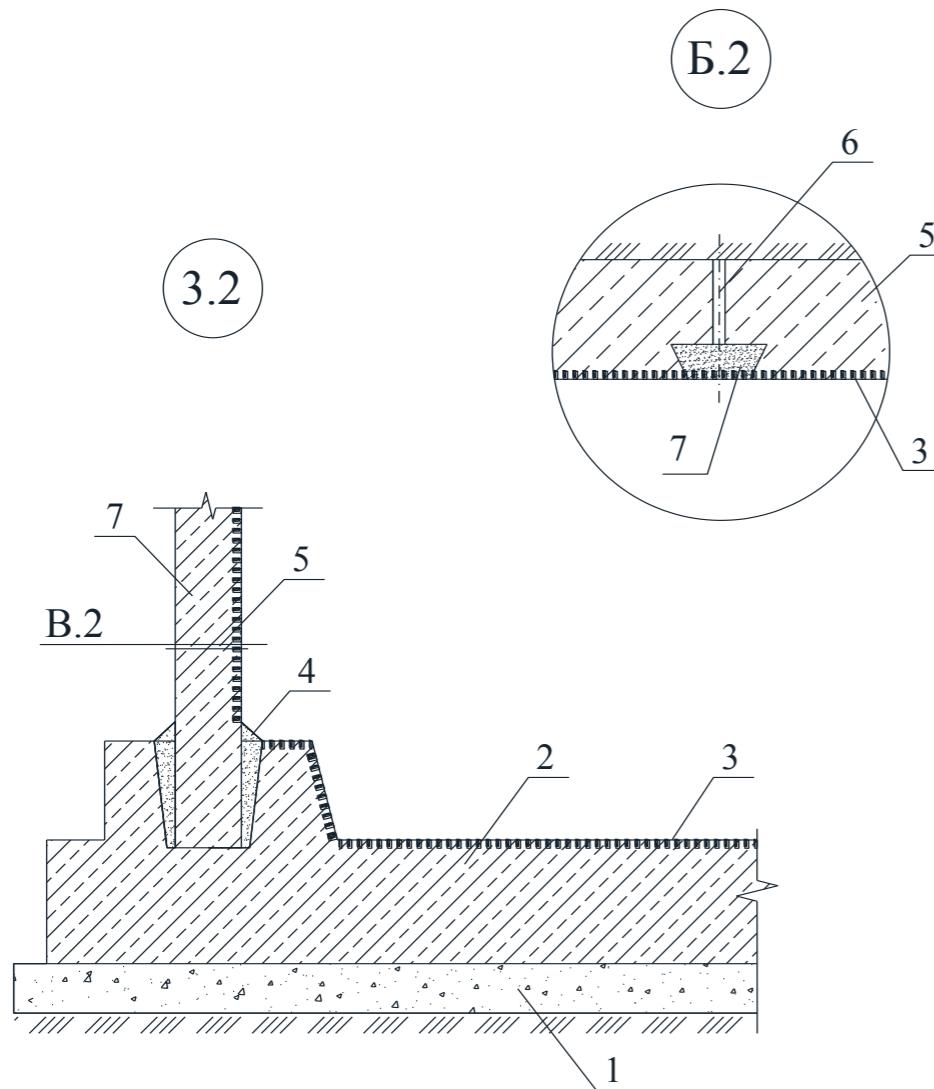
Узел 3.2 Сопряжение гидроизоляции фундаментной плиты и с борной стенки;
